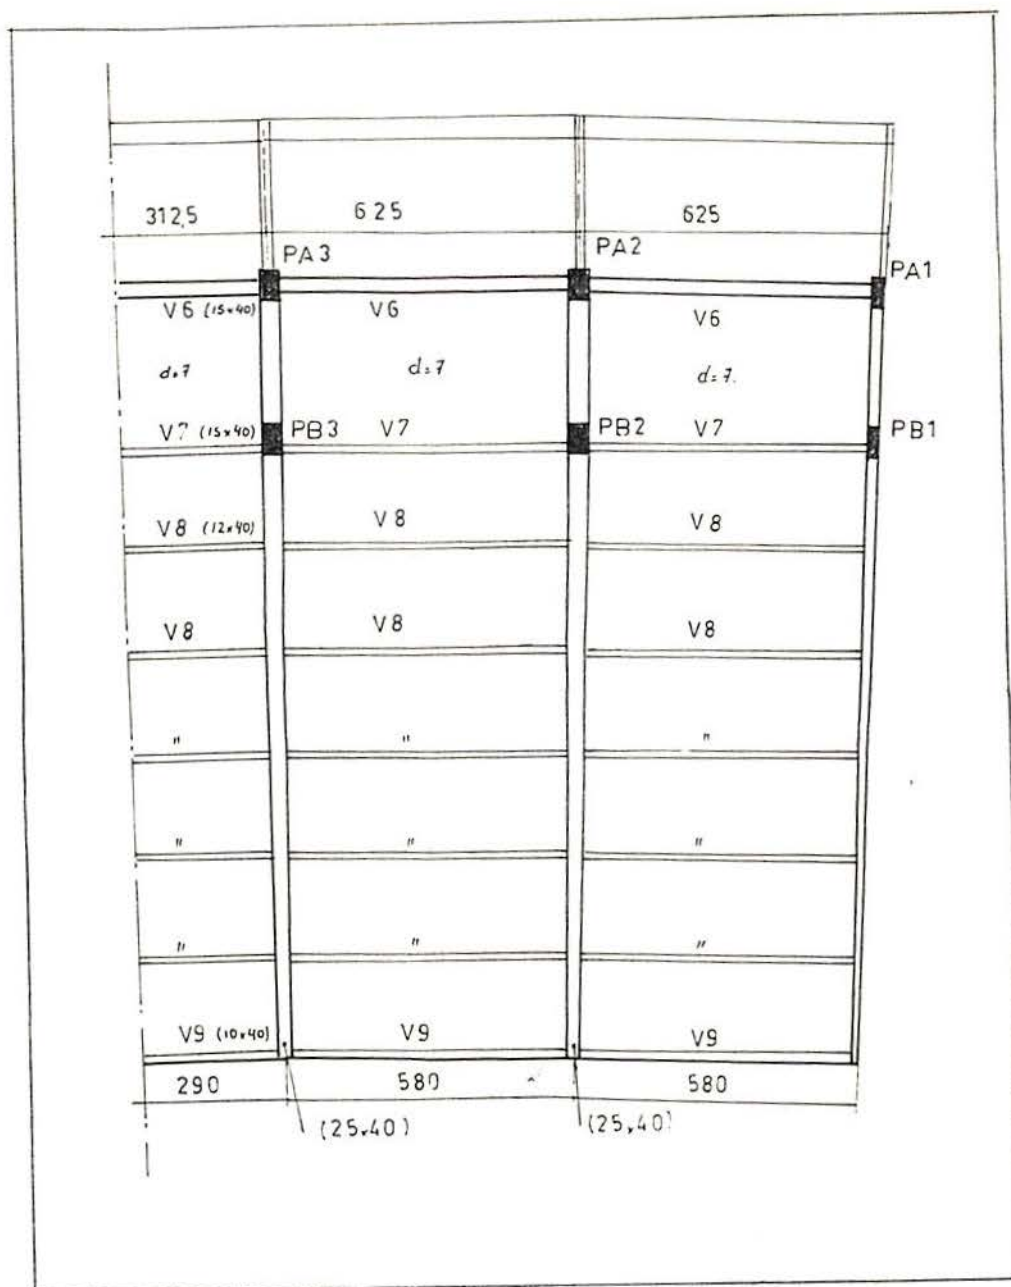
Vista superior da marquise do módulo. Dimensões de vigas e lajes, espessura dos pórticos.
